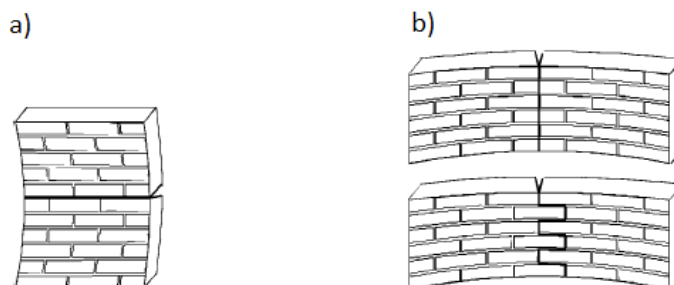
Řez a půdorys nevyztuženou stěnou vystavenou sání větru
